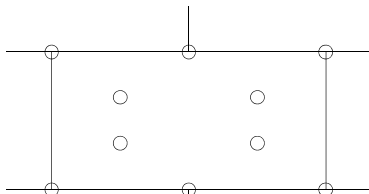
Plans de chevillage - panneaux de dimensions 1200 x 600 mm
